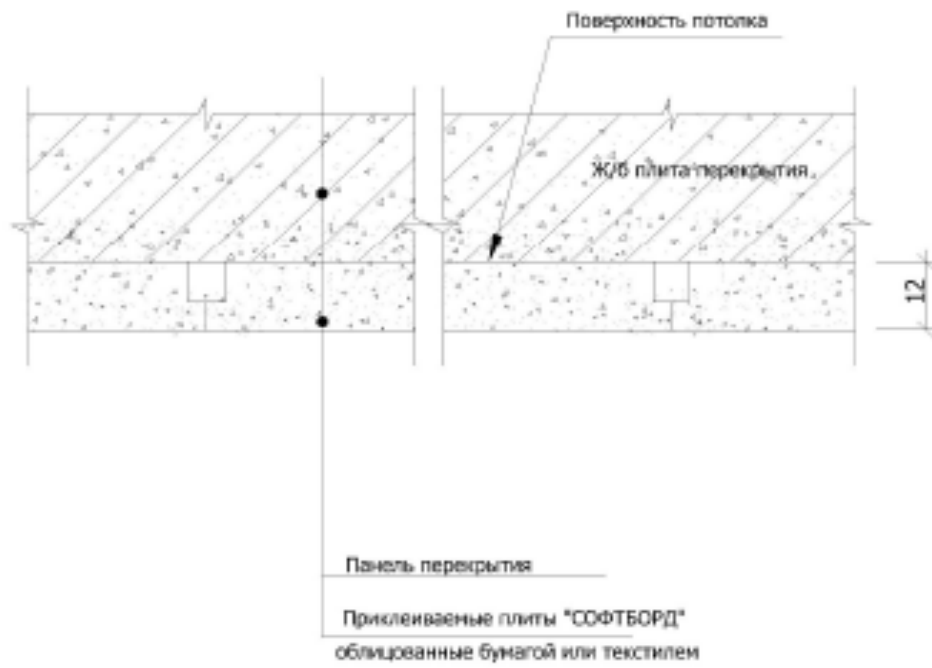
Облицовка потолка плитой СОФТБОРД
